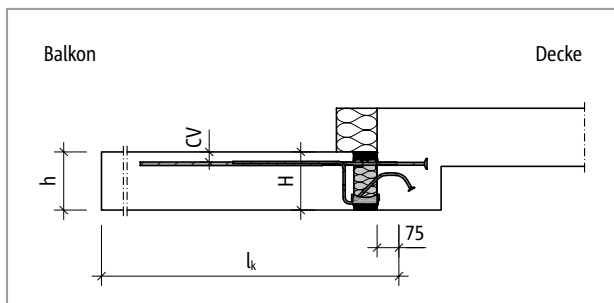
Schöck Isokorb® T Typ K-U: Statisches System
